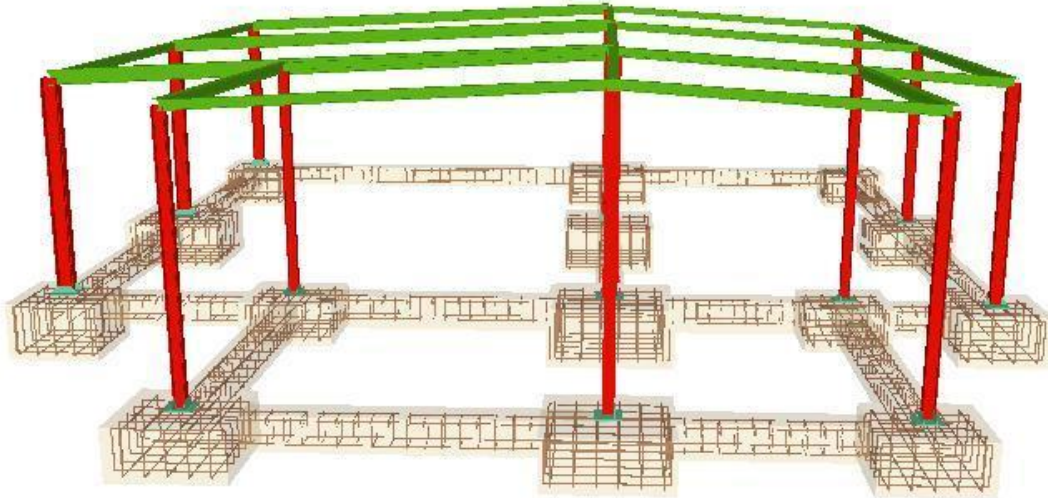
Estructura metálica y cimentaciones del edificio de servicios.
